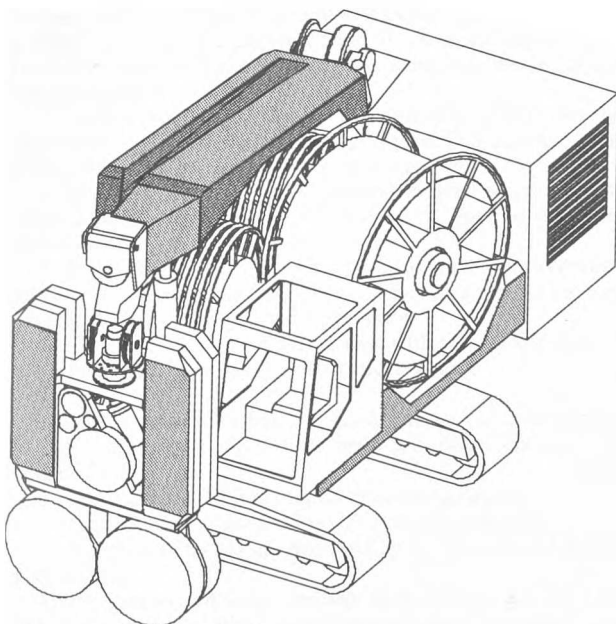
Exemple de machine pour excaver les parois : Hydrofraise compacte.
